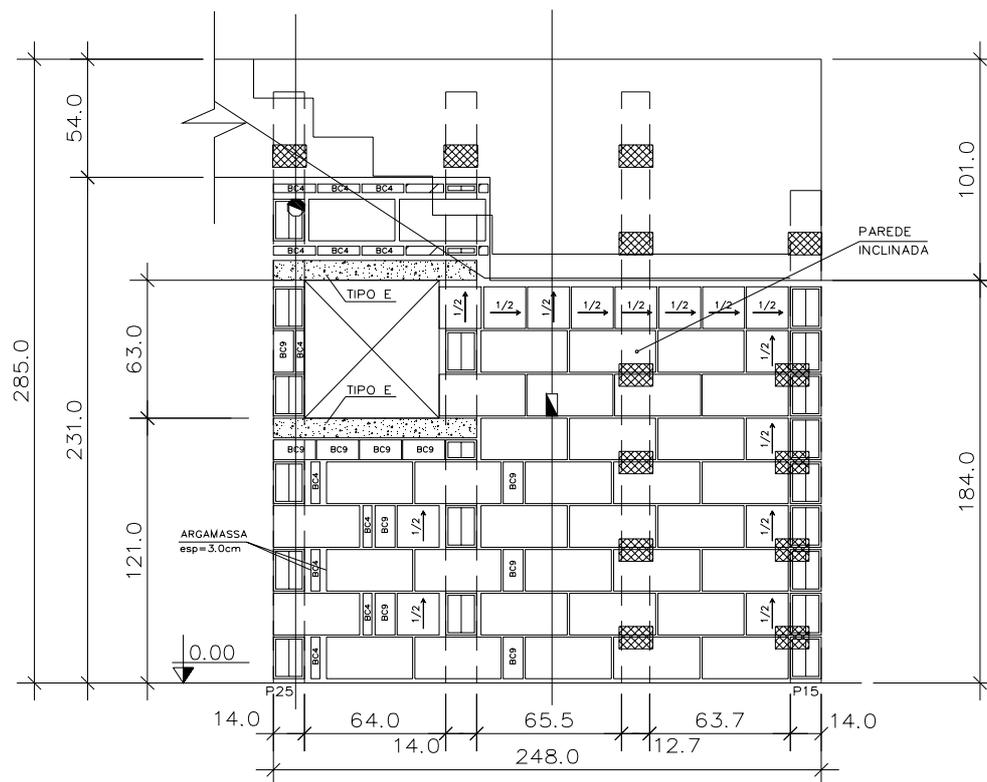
Elevação da parede lateral na entrada da escada indicada inicialmente pelo projeto de vedação.
